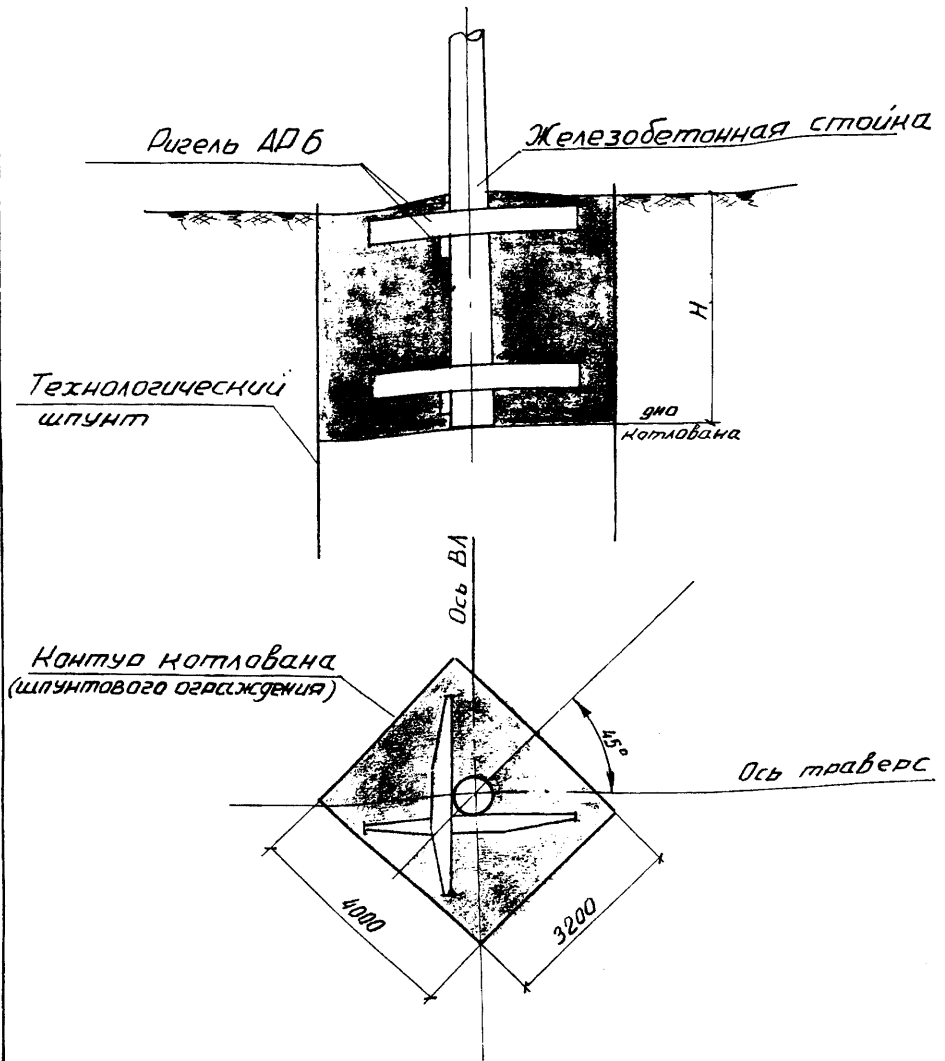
Закрепление железобетонной стойки в грунте. Тип I
